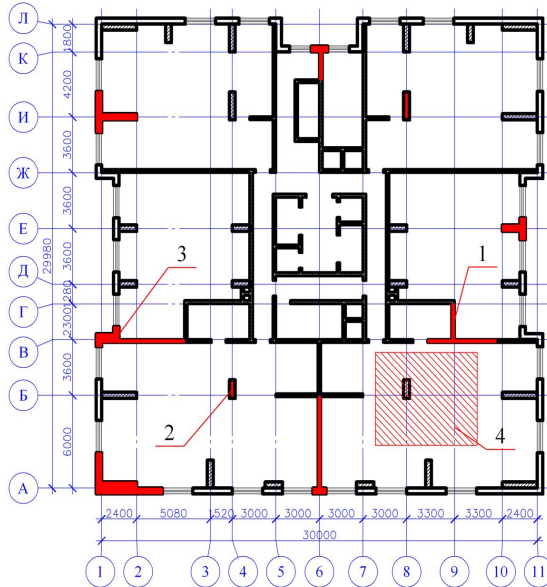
Возможные варианты внезапного выключения из работы несущих элементов здания: 1 – части несущей стены, 2 – колонны, 3 – фрагмента наружной стены, 4 – части перекрытия.
